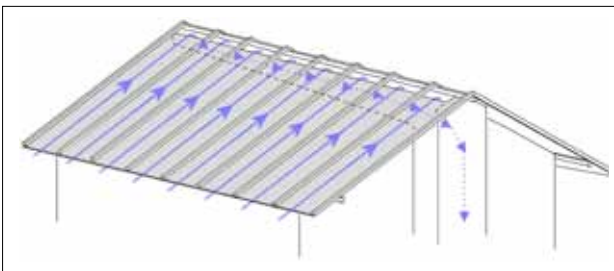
Dachabsaugung bei einem Sparrendach und Sammelkanal im Firstbereich
